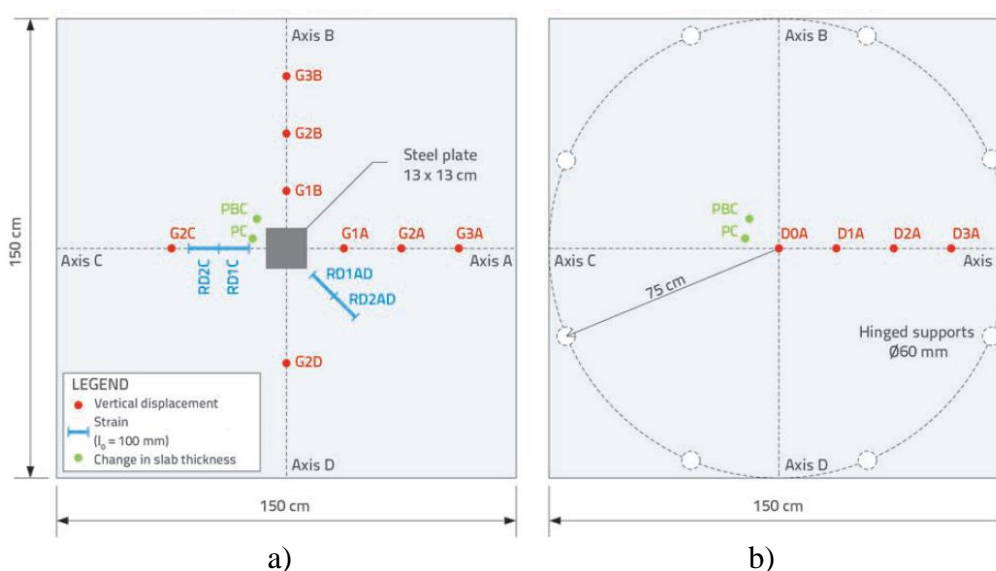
Vista em planta dos pontos de medição das lajes; a) Lado superior; b) lado inferior, (<https://www.researchgate.net/publication/282097318>).
